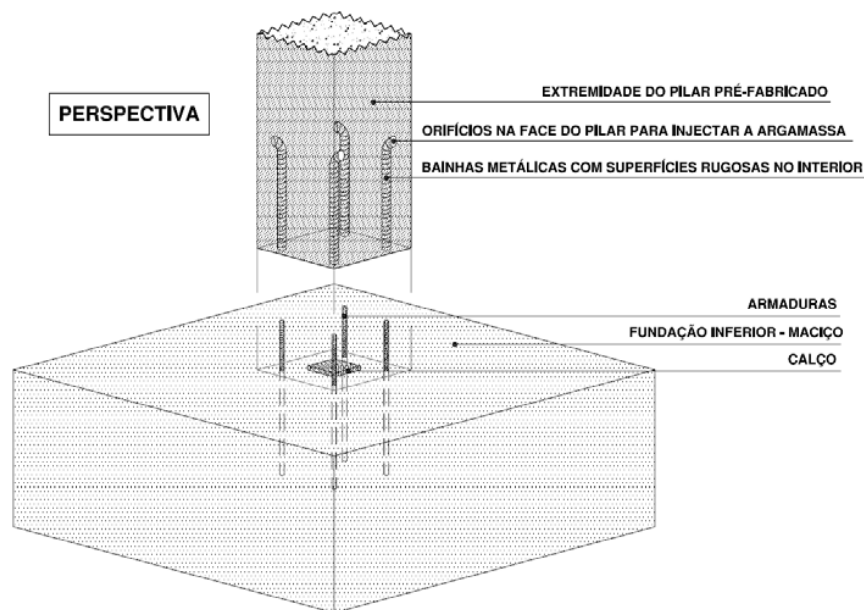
Ligação pilar – fundação com Armaduras salientes da fundação (retirado de (REGUENGO, 2010))
